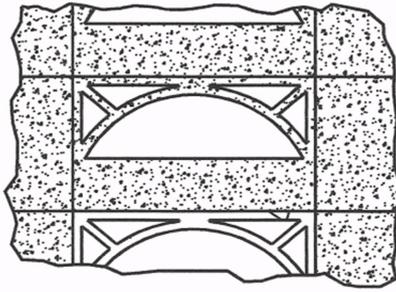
Ограждение лоджии, усиленное железобетонной рамкой
